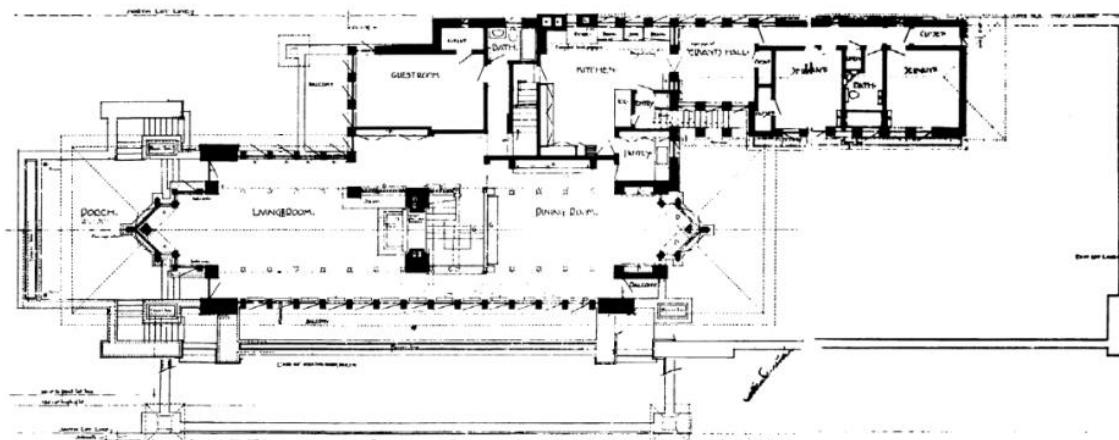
Robie House (1910), planta baixa do primeiro pavimento.
